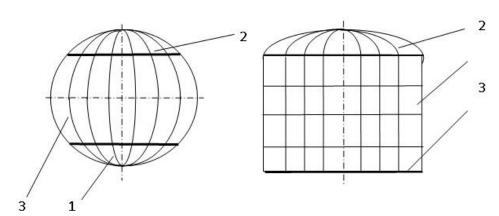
Типовые сооружения, изготавливаемые с использованием методов штамповки: а – сферический резервуар; б – цилиндрический резервуар; 1 – нижнее днище; 2 – верхнее днище; 3 – пояс резервуара
